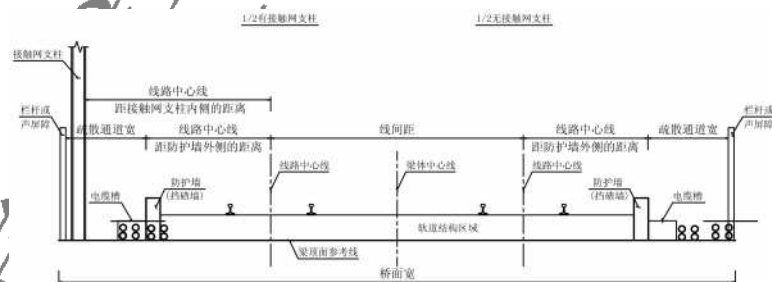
双线桥面布置示意图(一)(疏散通道位于两侧)
